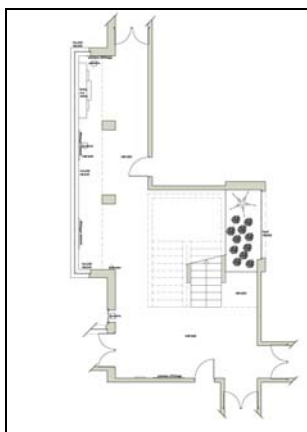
Plan proposé aux participants. Une copie de ce plan 'taille réelle' est jointe en annexe.
